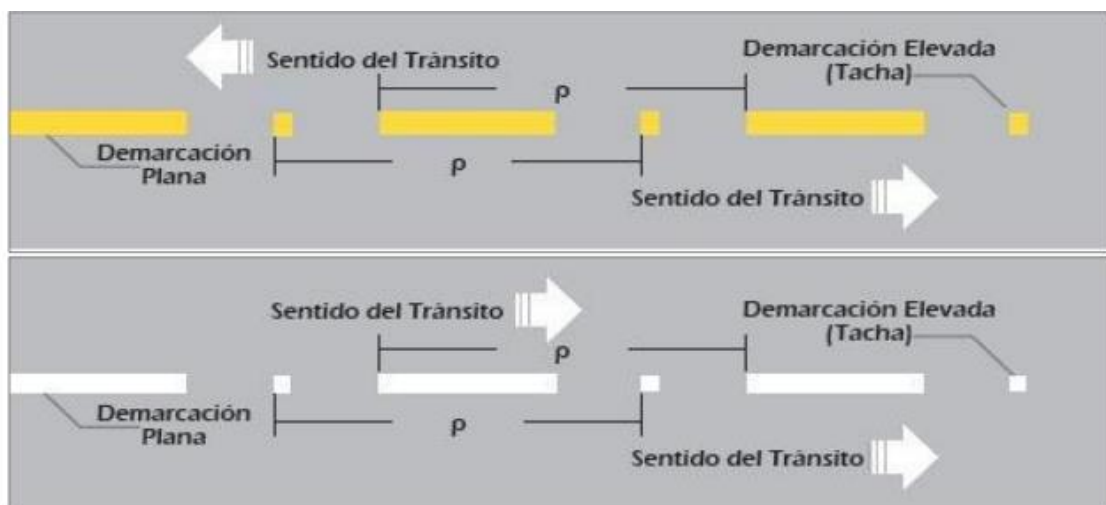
Modelos de cómo se ubican las líneas segmentadas en el pavimento fraccionadas "p".
